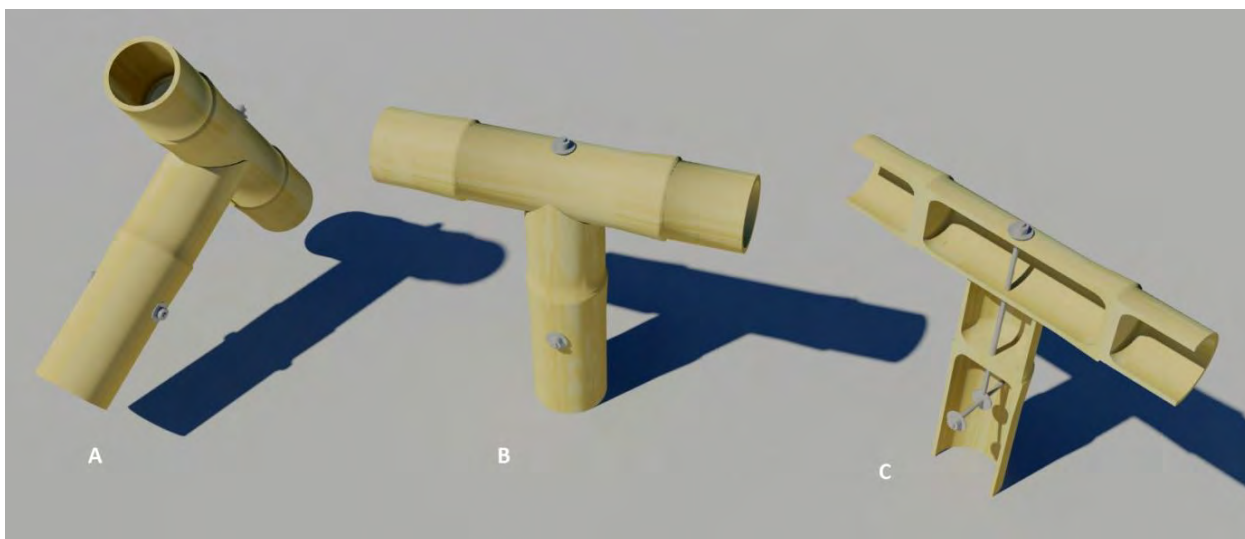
Conexión boca de pescado: A. perspectiva; B. frente; C. corte transversal con detalle de unión. (Elaborado por el autor basado en Leyva 2014)
